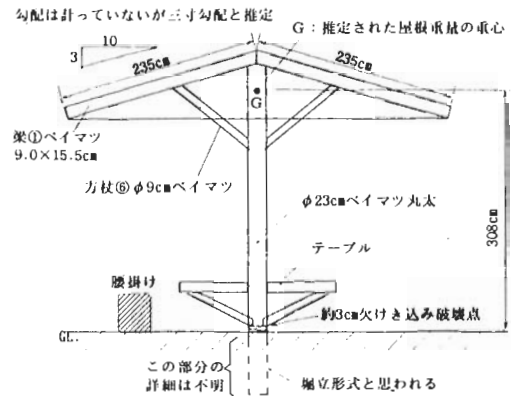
No.18パラソル型東屋のおよその形状と寸法（立面：一部推定）
